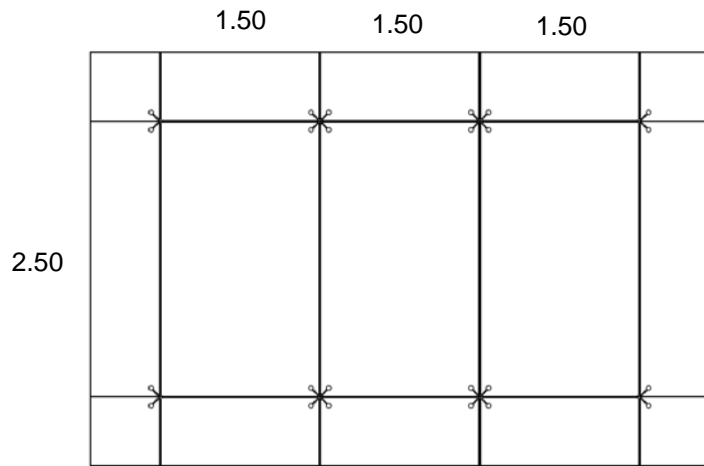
Detalle del modulo del muro cortina (fachada de cristal) con sistema Archixpider
